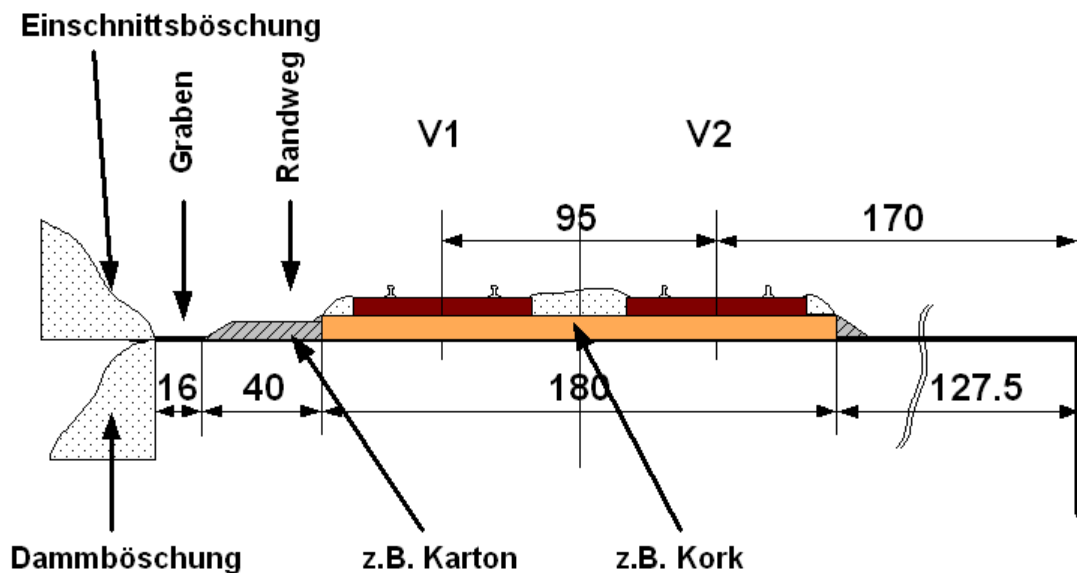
Bahnkörper für zweigleisige Strecke (gerade Strecke)
